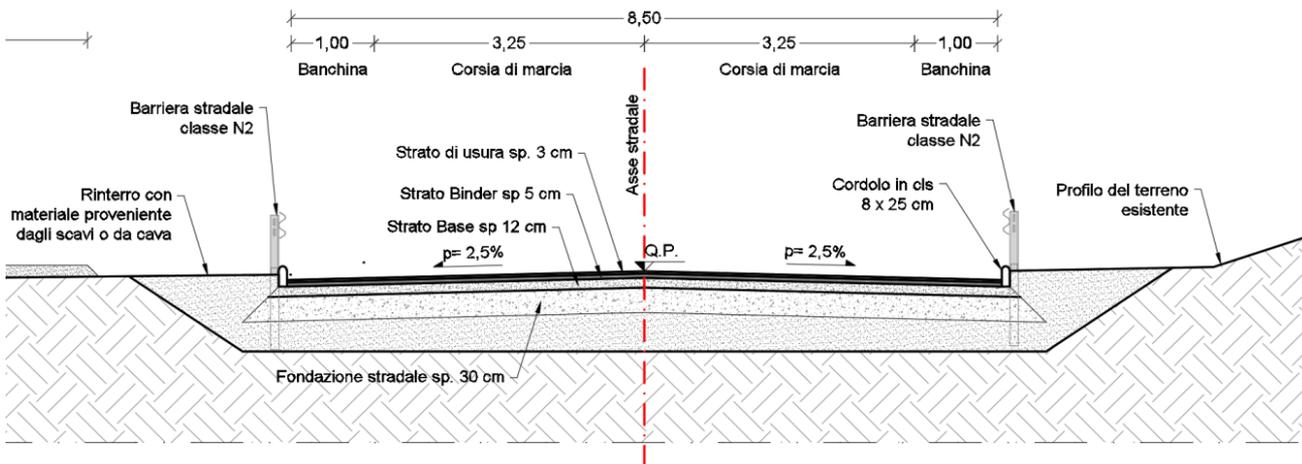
Raccordo di collegamento porto - SS18. Sezione tipologica viabilità di progetto
